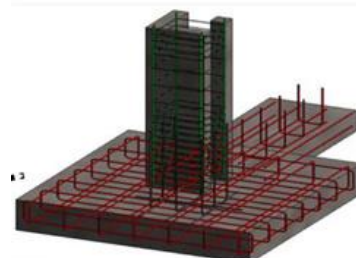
Détail d'encrage du poteau en béton armé aux fondations.
